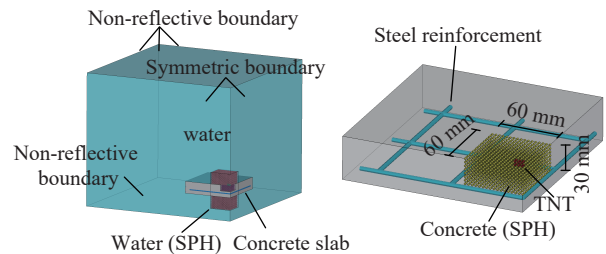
水下接触爆炸下钢筋混凝土板的数值模型
